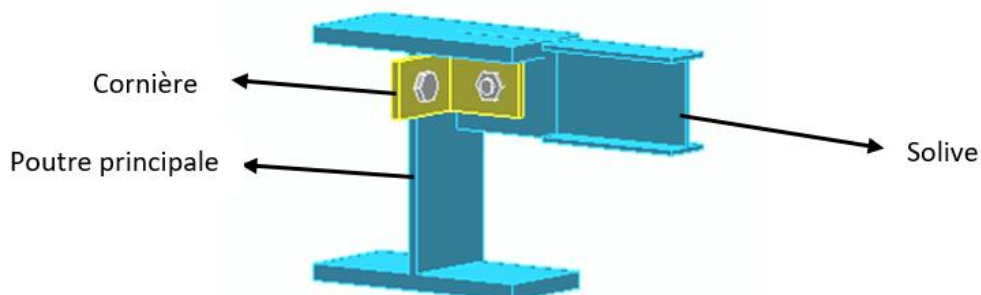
Assemblage poutre principale (HEB260) – solive (IPE100).
